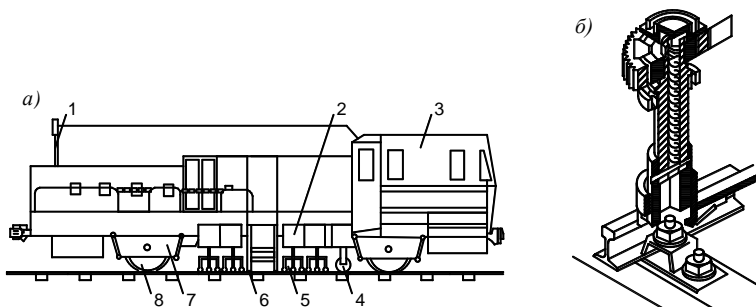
Конструктивная схема путевого моторного гайковерта ПМГ:
